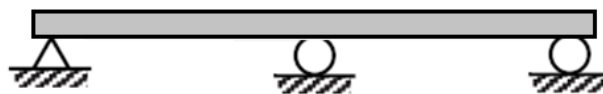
Viga articulada y doblemente apoyada (Flores, 2018).
